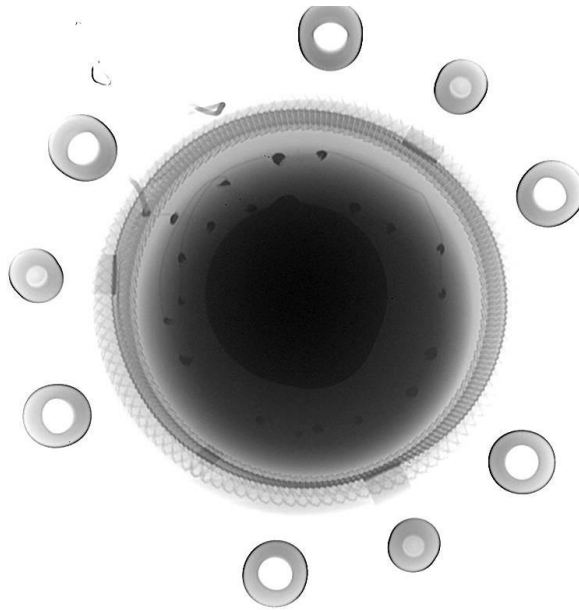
Vista 1 em planta do perfil superior do isolador 3 em RX.
